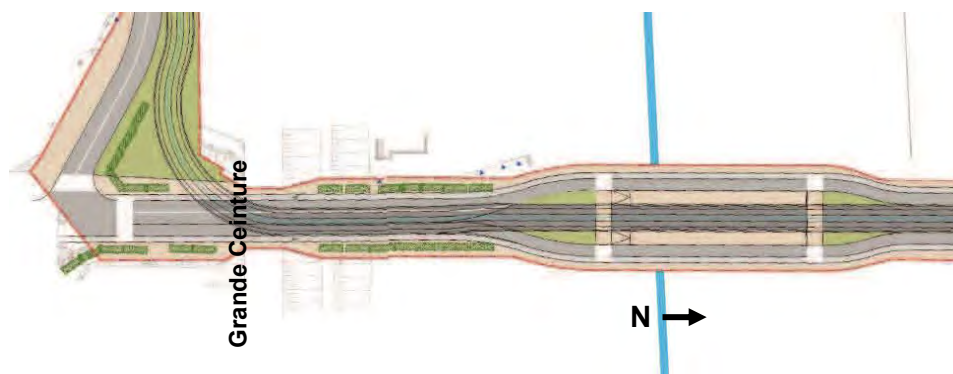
Insertion de principe en site mixte sous l'ouvrage
